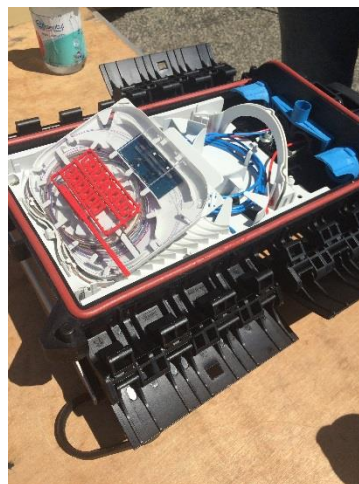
Vue de l'intérieur du boîtier d'épissure après les soudures
